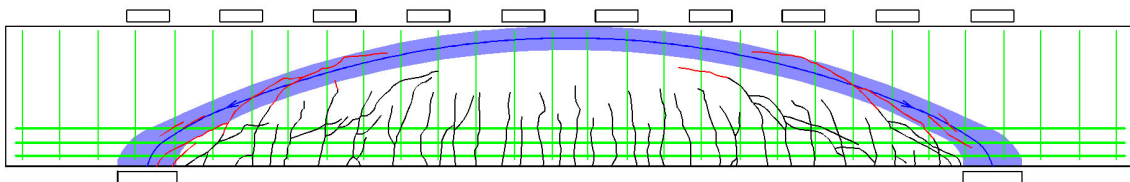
Balken C 6 mit überlagerter Druckparabel und zugehörigen Rissen
